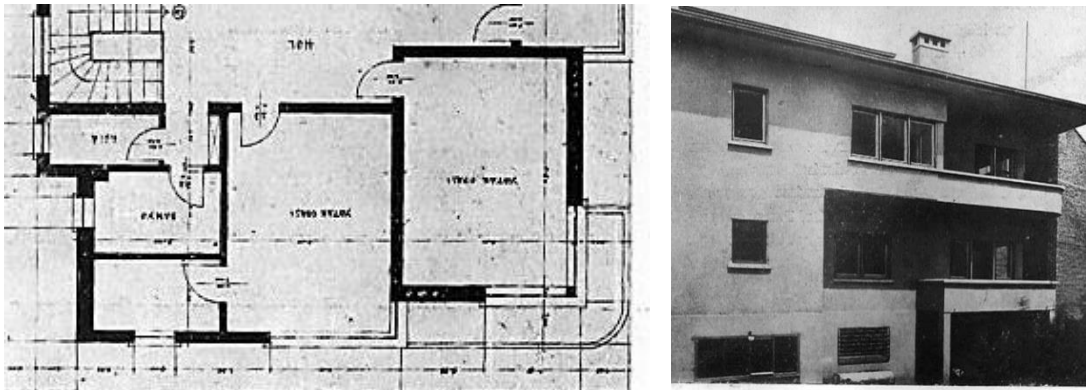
Köşe Balkon Plan ve Görünüş (Hüsni, 1933)
